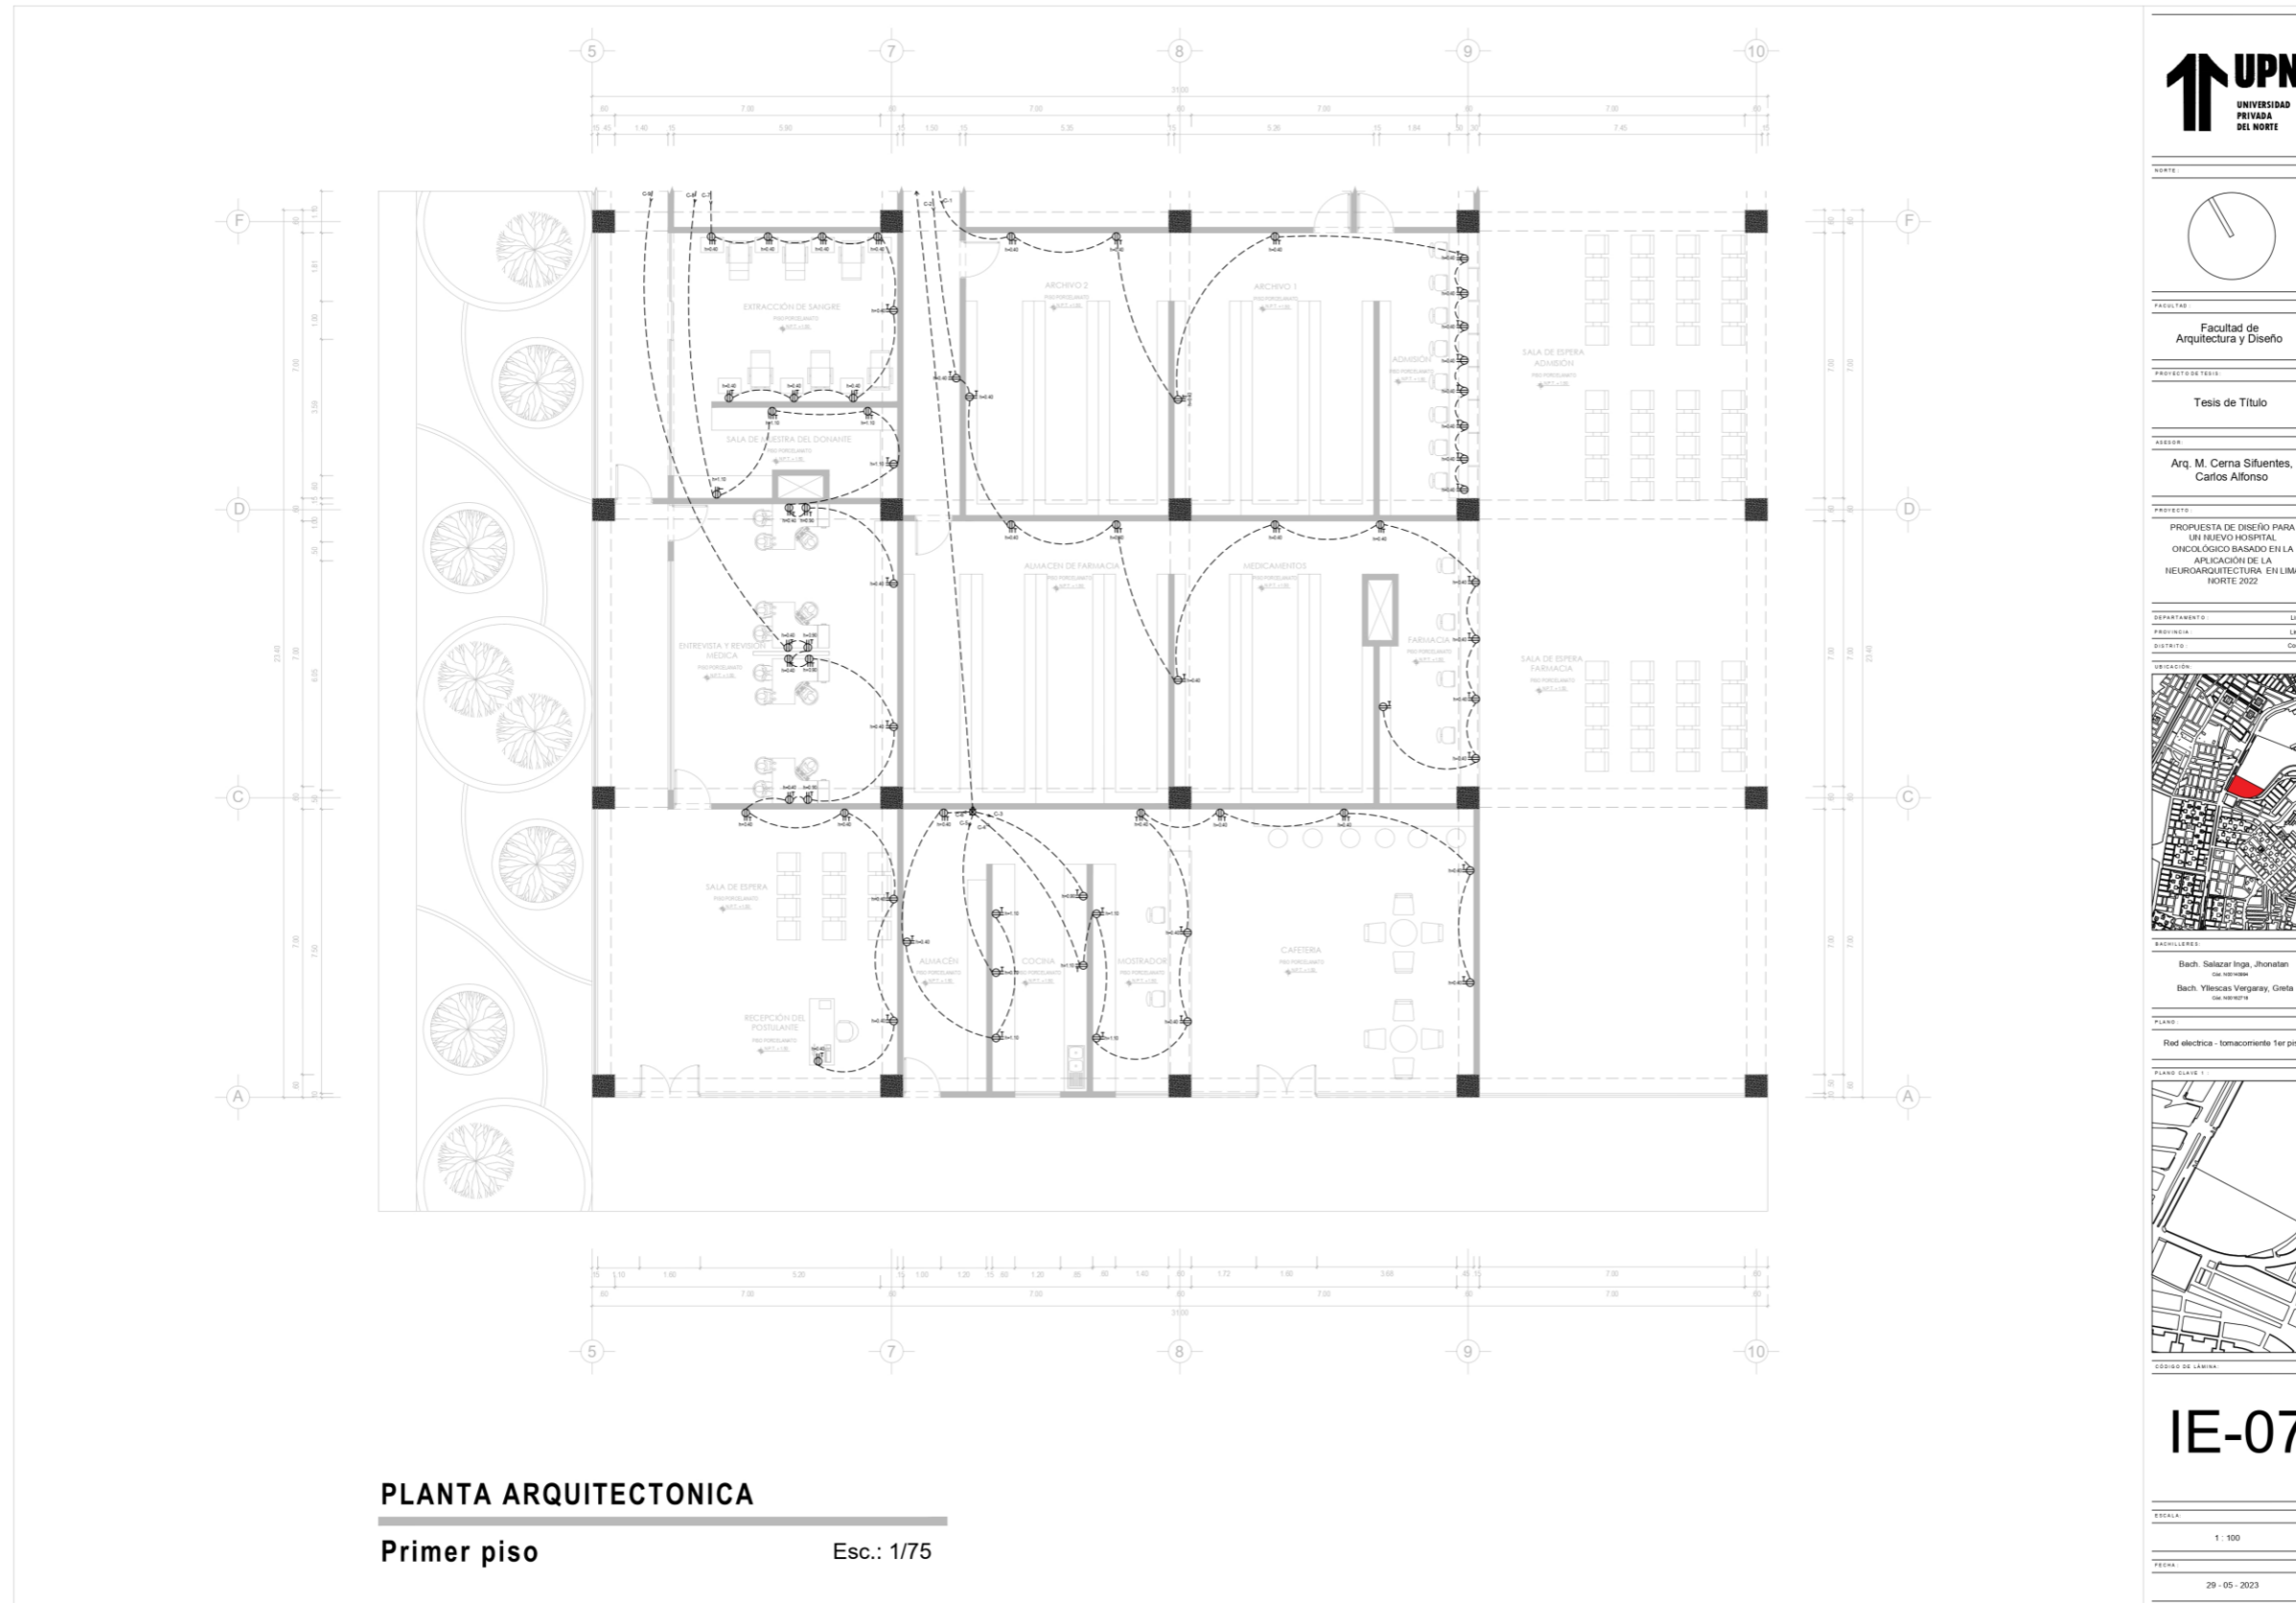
Instalaciones Eléctricas – Tomacorriente Nivel N°1 del sector cuadrante Esc: 1/75 (Fuente: Elaboración propia de los coautores)
